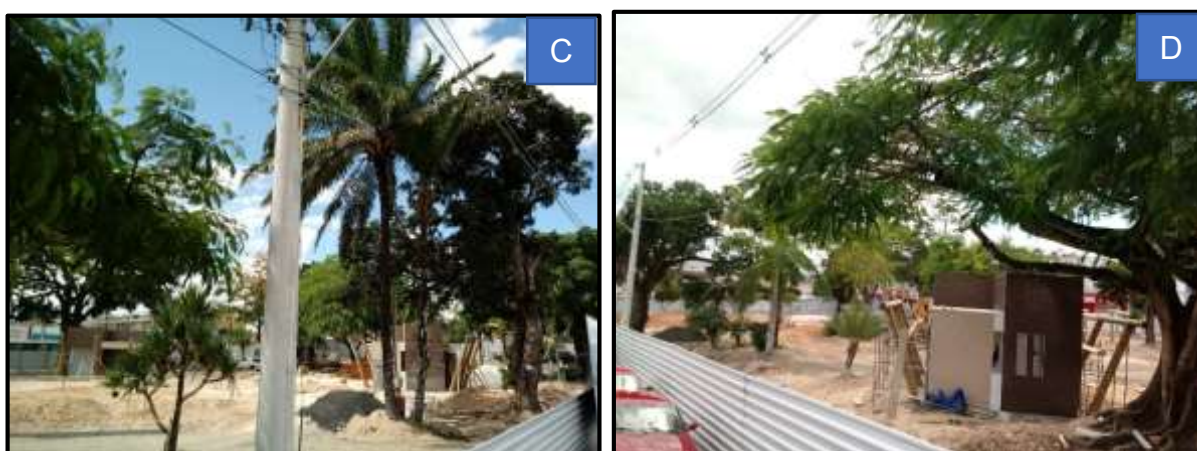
C e D: Vista Interna da Praça Rui Barbosa com Solo Ainda Suspenso pelas Obras.
